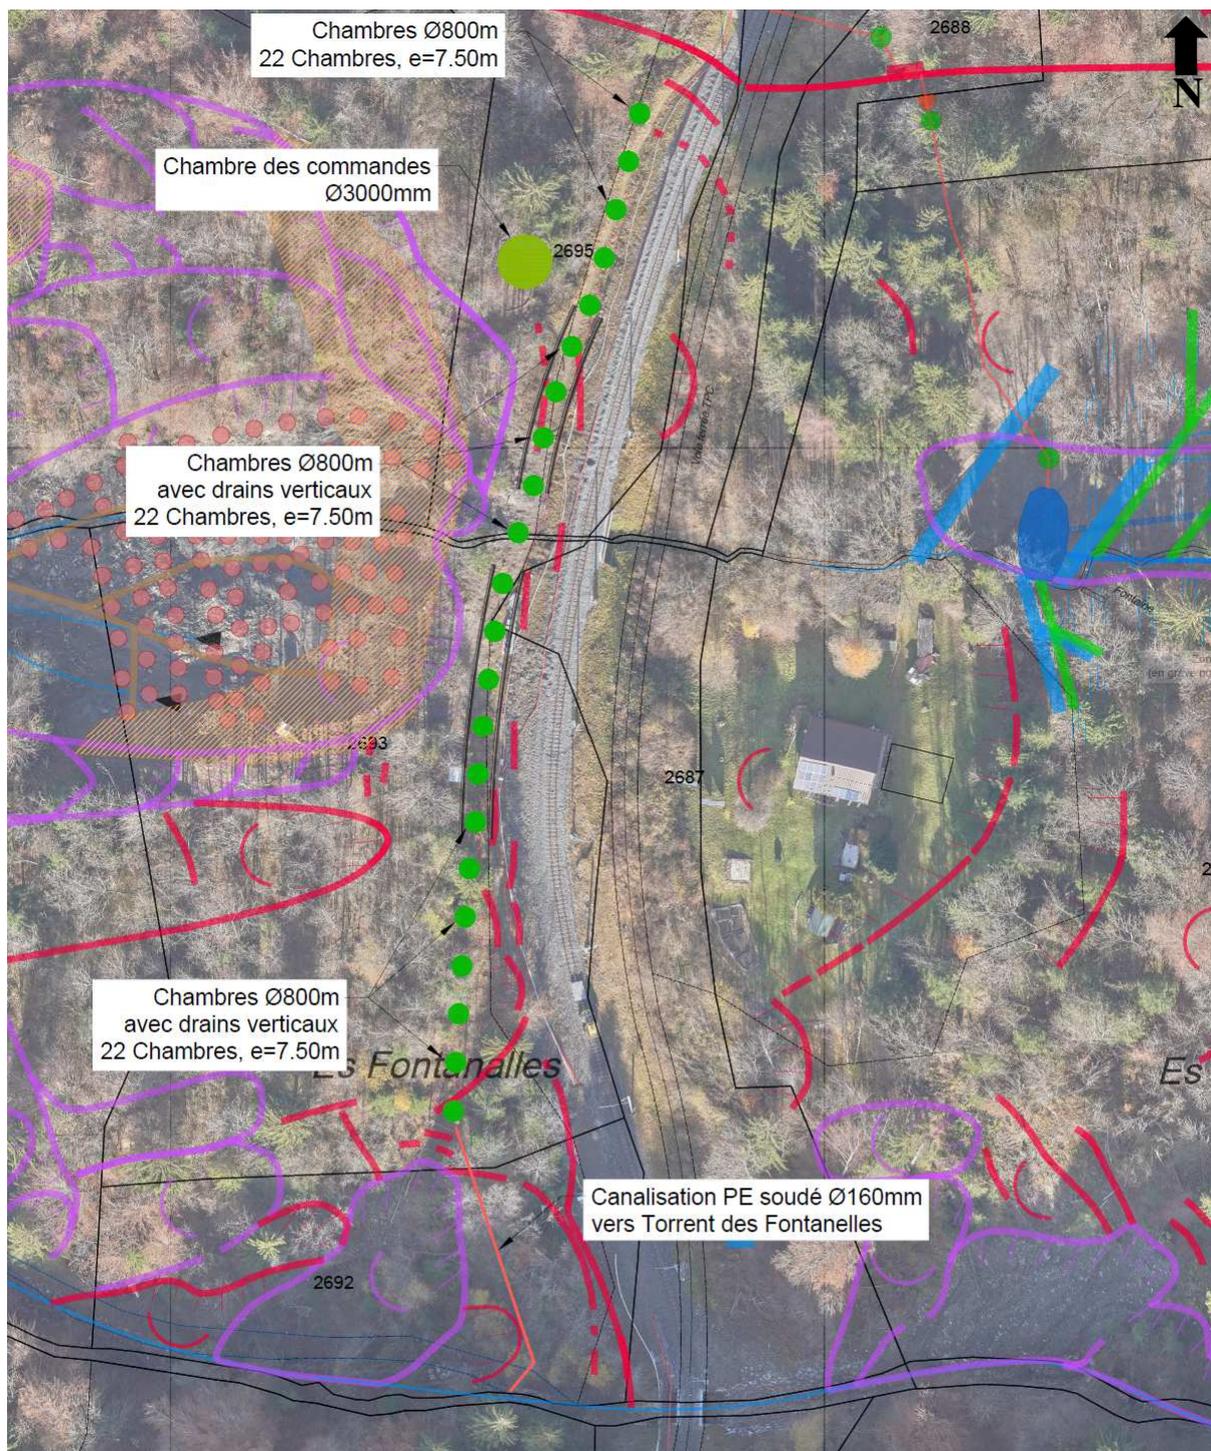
Plan des drains verticaux (aval de la voie). Tiré de (1).
